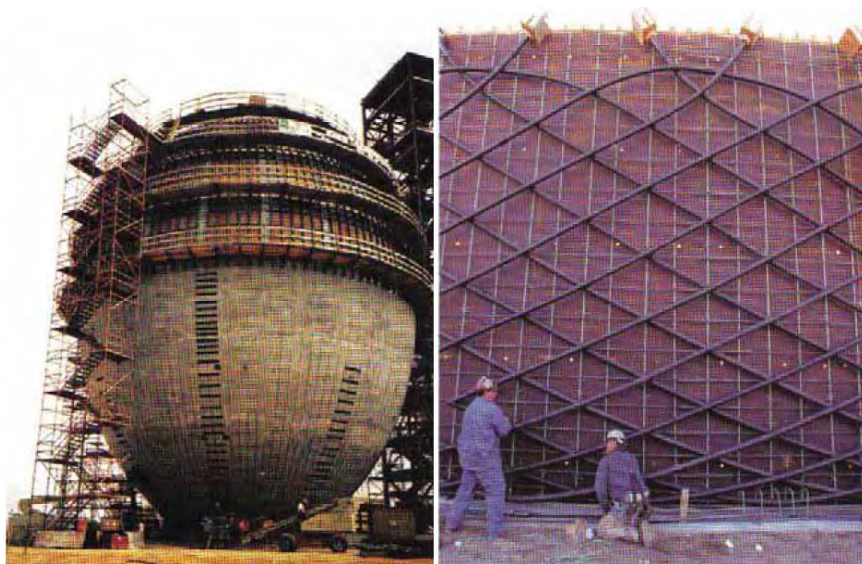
Резервуар яйцеобразной формы (DSI, Германия) и пример раскладки напрягаемой арматуры в стенке резервуара квадратной в плане формы [10]
